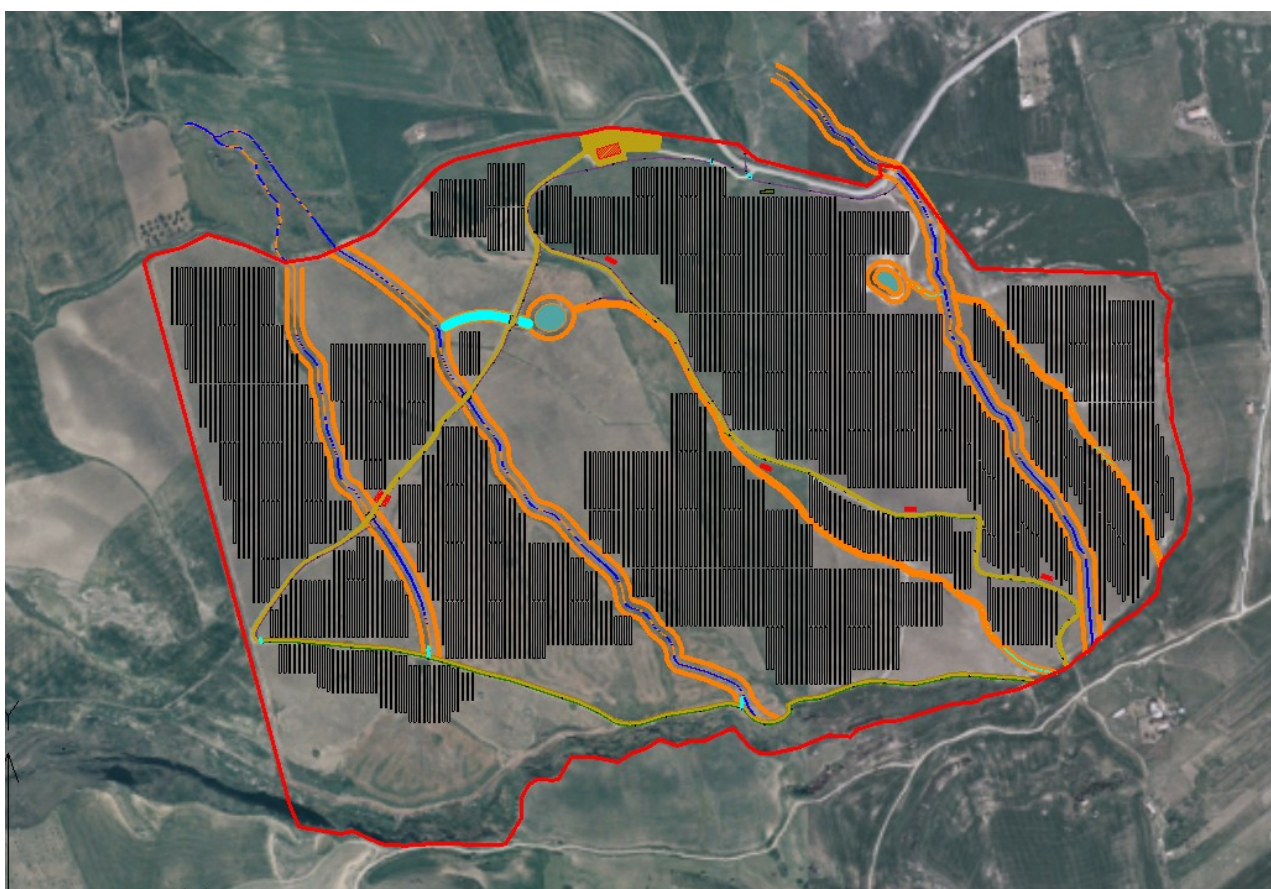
Stralcio elaborato con indicazione della viabilità da mantenere e dei canali con la fascia di rispetto da 10 metri prevista in progetto
